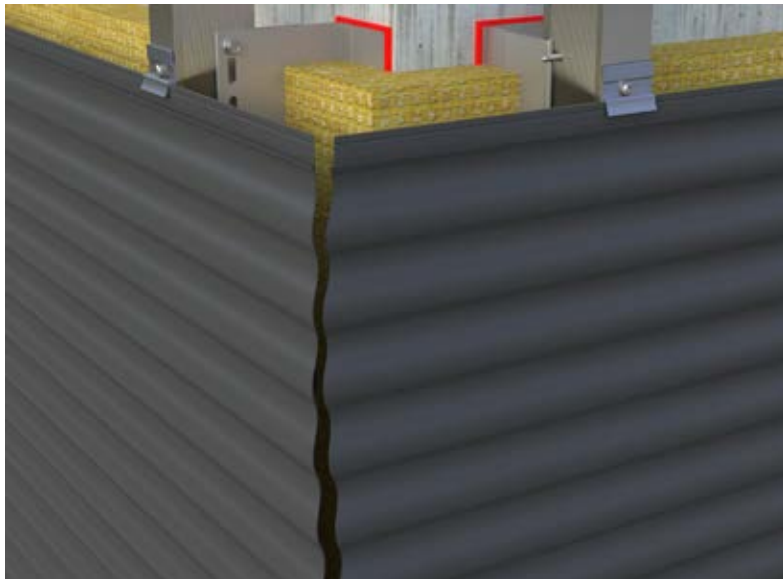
• Profil kantowany do narożnika zewnętrznego
